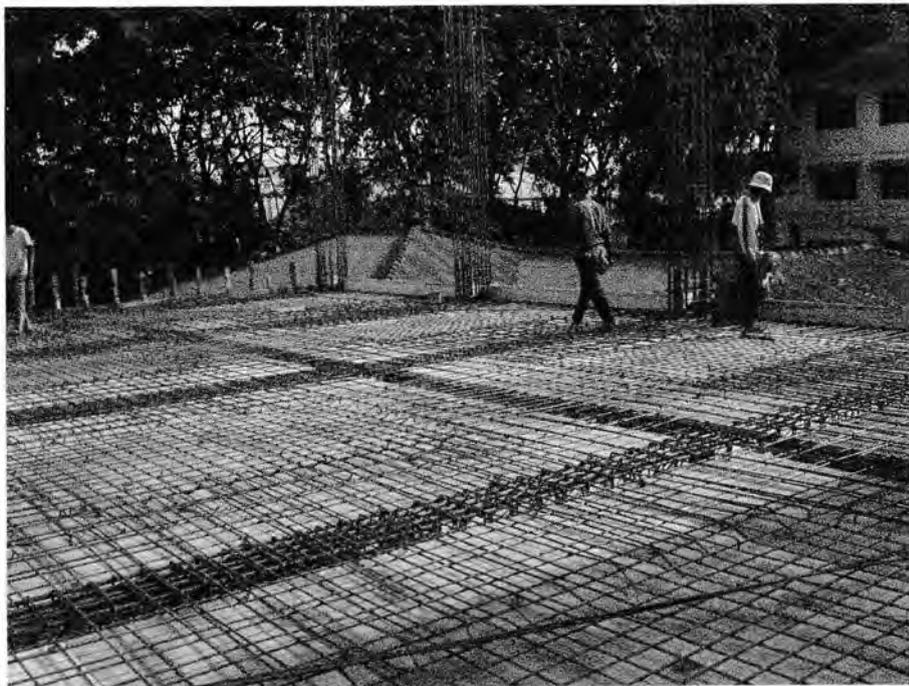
Tampak Bangunan Gedung dan Strukturnya
